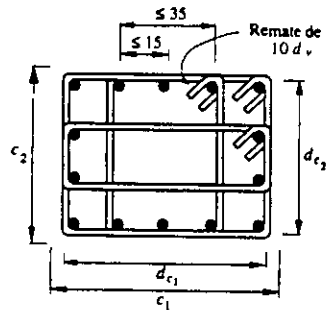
Requisitos de distribución de refuerzo en columnas de estribos.
